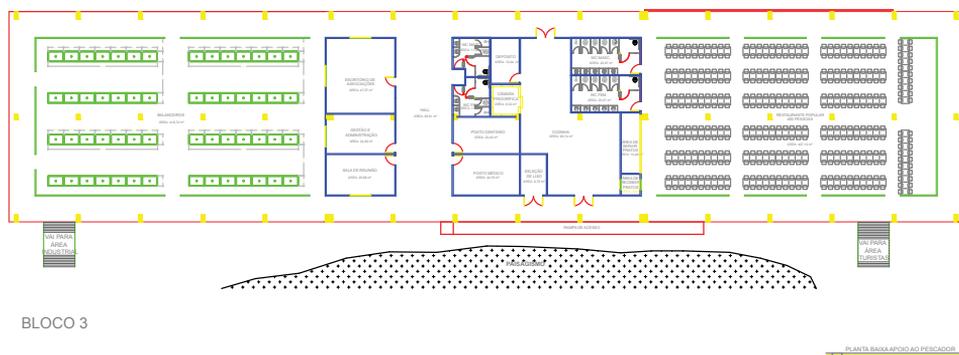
Planta baixa do bloco de apoio ao pescador – Bloco 03
